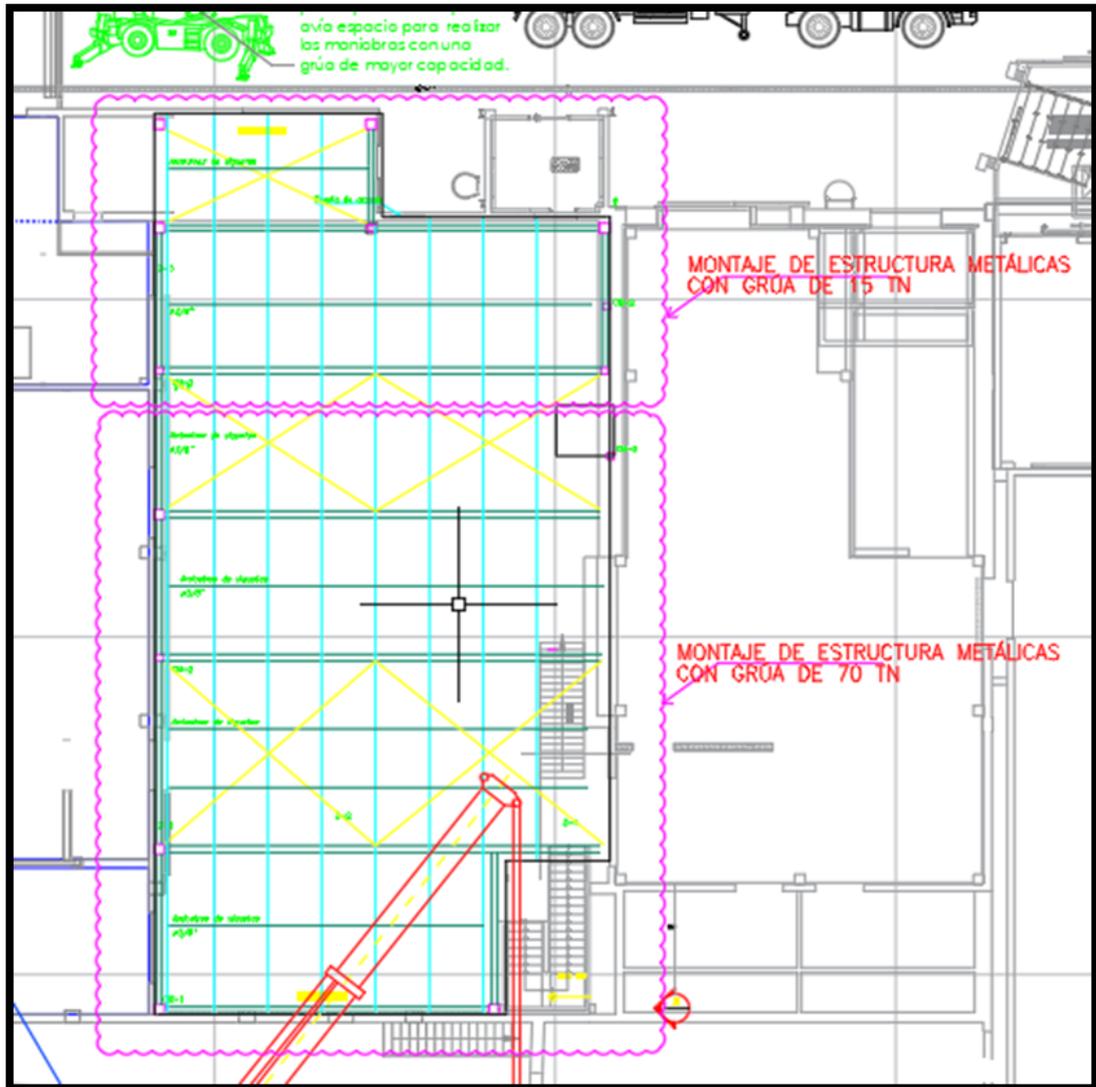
Layout de Distribución Montaje de estructura metálica 1er nivel
